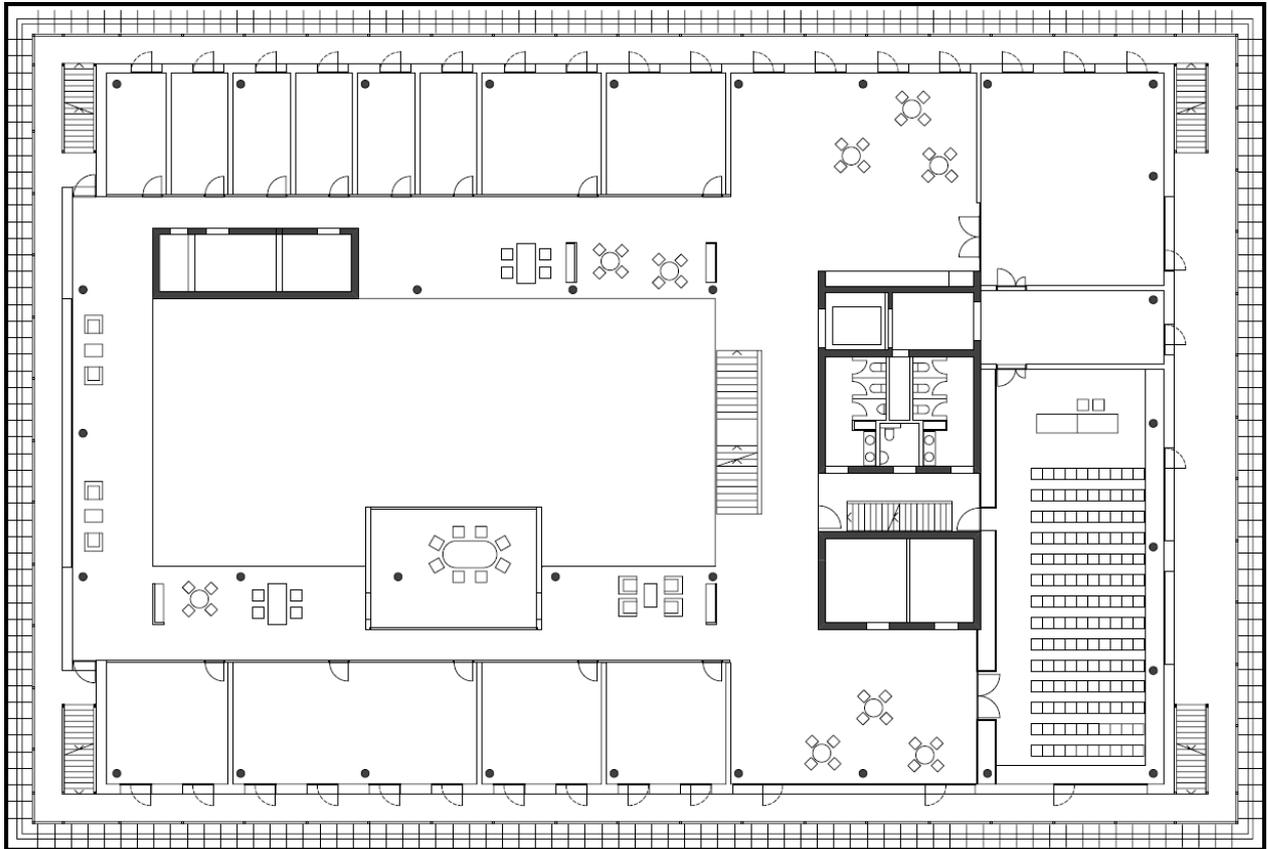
Grundriss des C-Geschosses mit Vortragssaal und Seminarraum an der Nordseite. (BGP)
